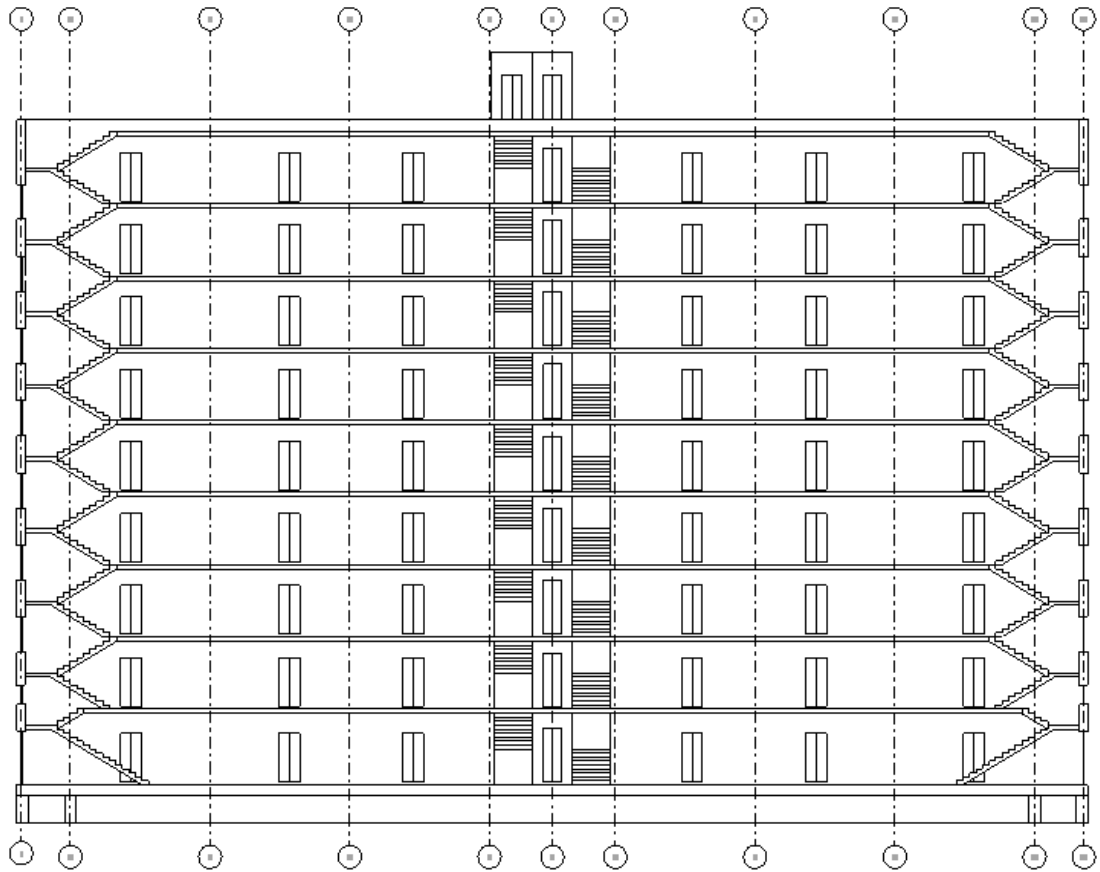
Розріз по головному фасаді будівлі 3 – го типу
